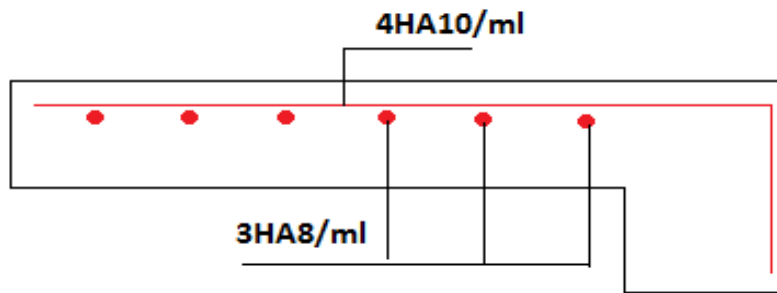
Detaille schéma de ferrailage de la volée 2 étage courant
